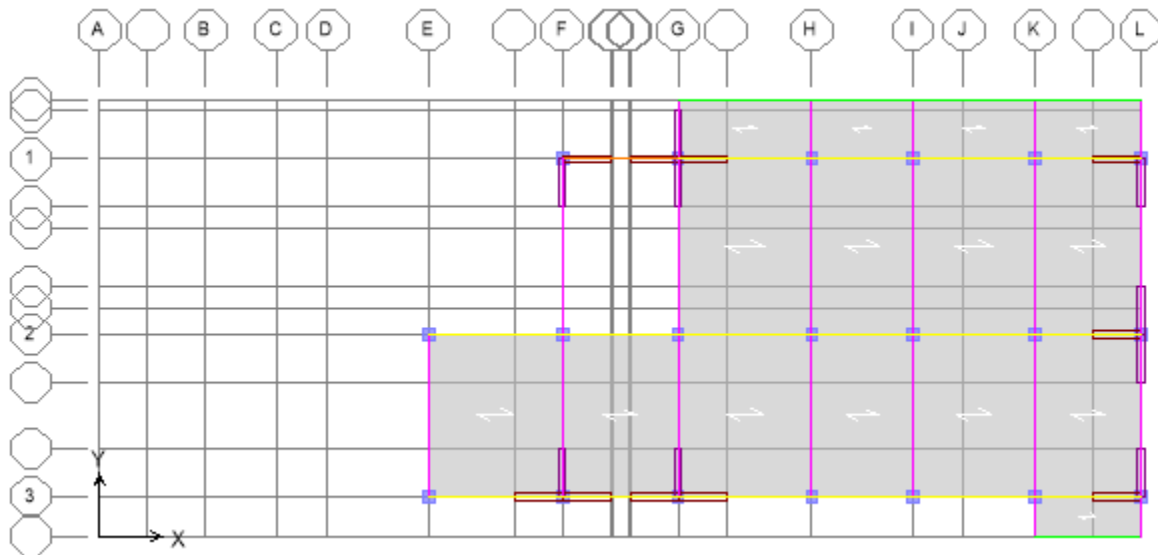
Vue en plan (2D) De rez de chaussée jusqu'à 4<sup>ème</sup> étage
